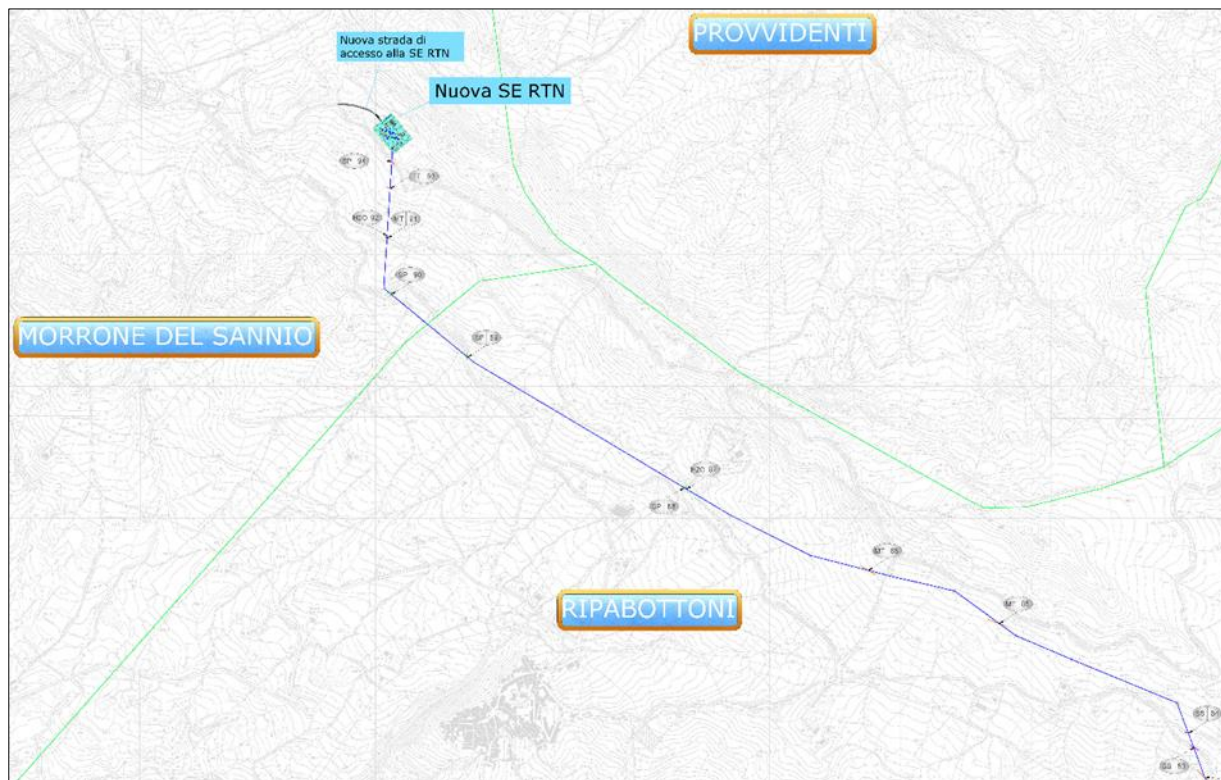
Stralcio planimetria tracciato elettrodotto su CTR (5/5)
